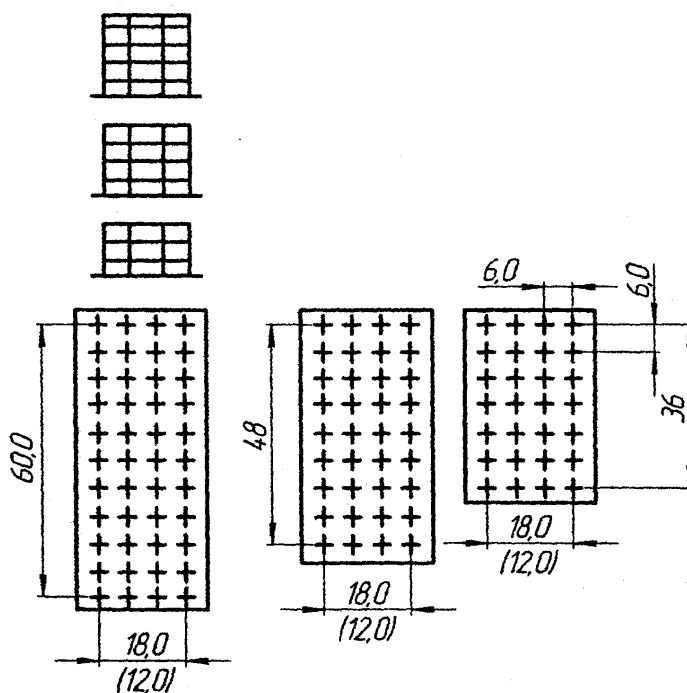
Схемы вспомогательных зданий из УТС
